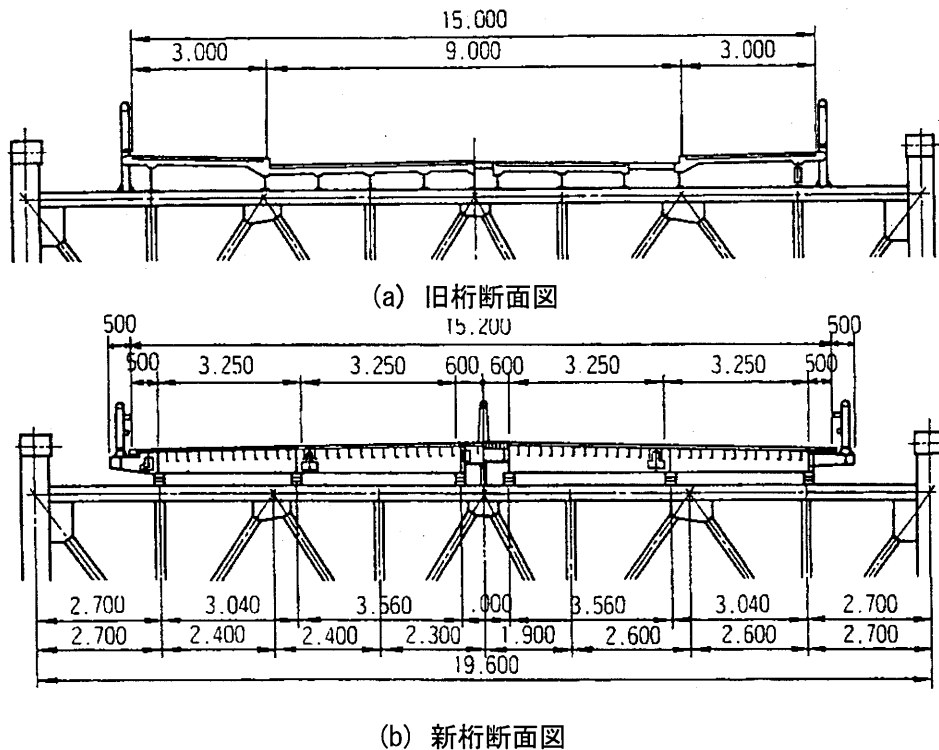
新旧桁断面図 (寸法単位: mm)
